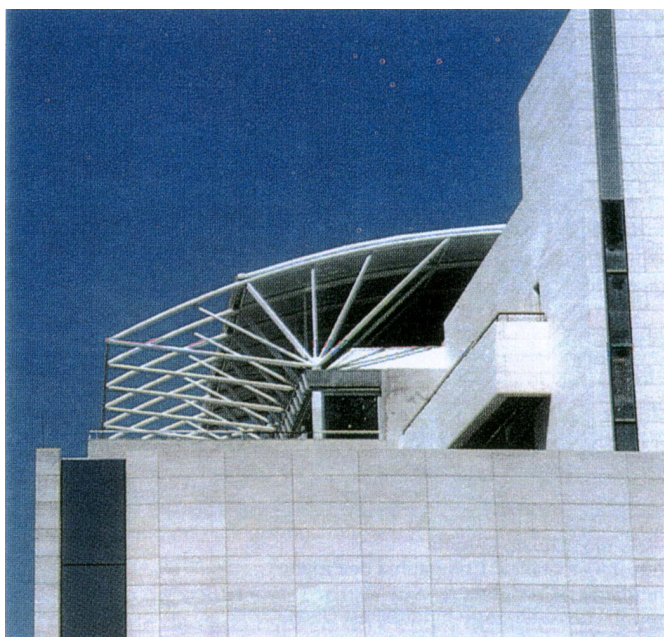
Vista cobertura treliçada em estrutura metálica
